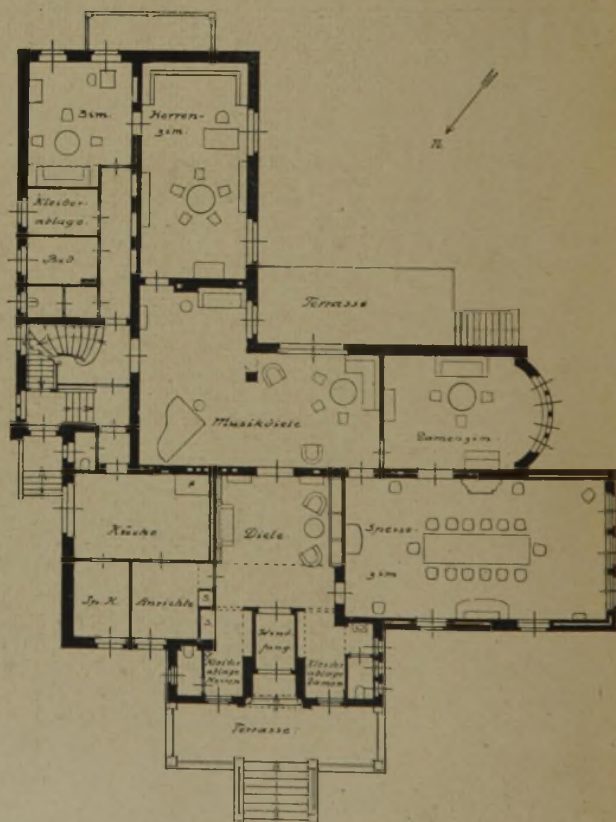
(hierüber). Grundriß vom Erdgeschoß vordem Umbau.
